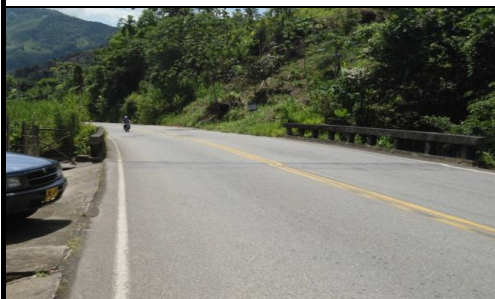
VISTA PANORÁMICA LONGITUDINAL
